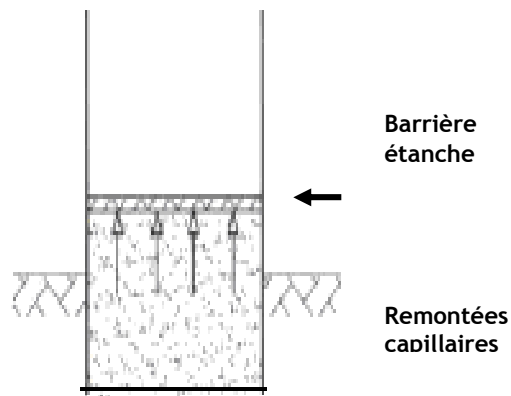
Application de barrière étanche à travers un mur sujet à des remontées capillaires
